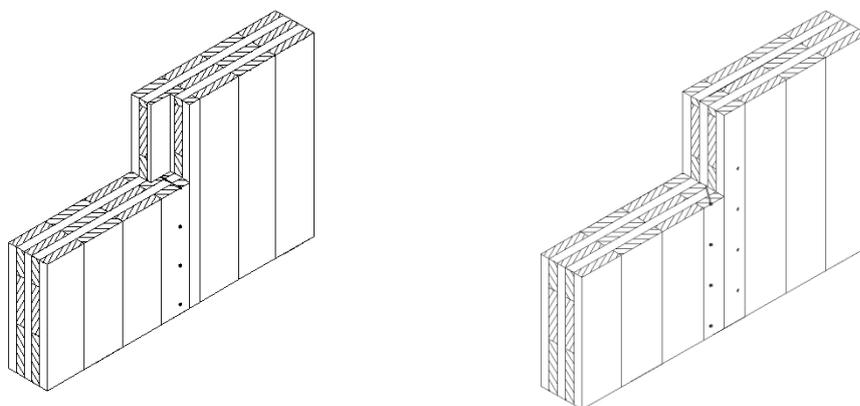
Collegamento parete-parete XLAM: giunto a mezzo legno avvitato e giunto con viti incrociate
